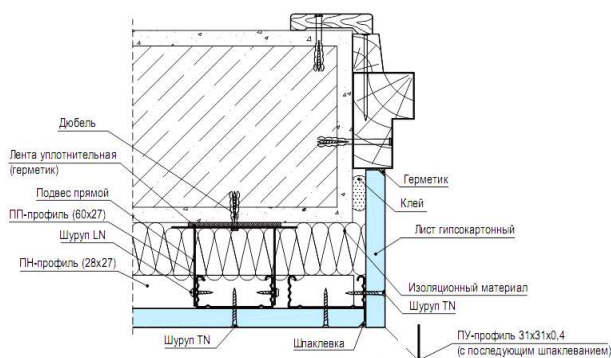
Примыкания облицовки стен к оконным и дверным проемам по каркасу на прямых подвесах
